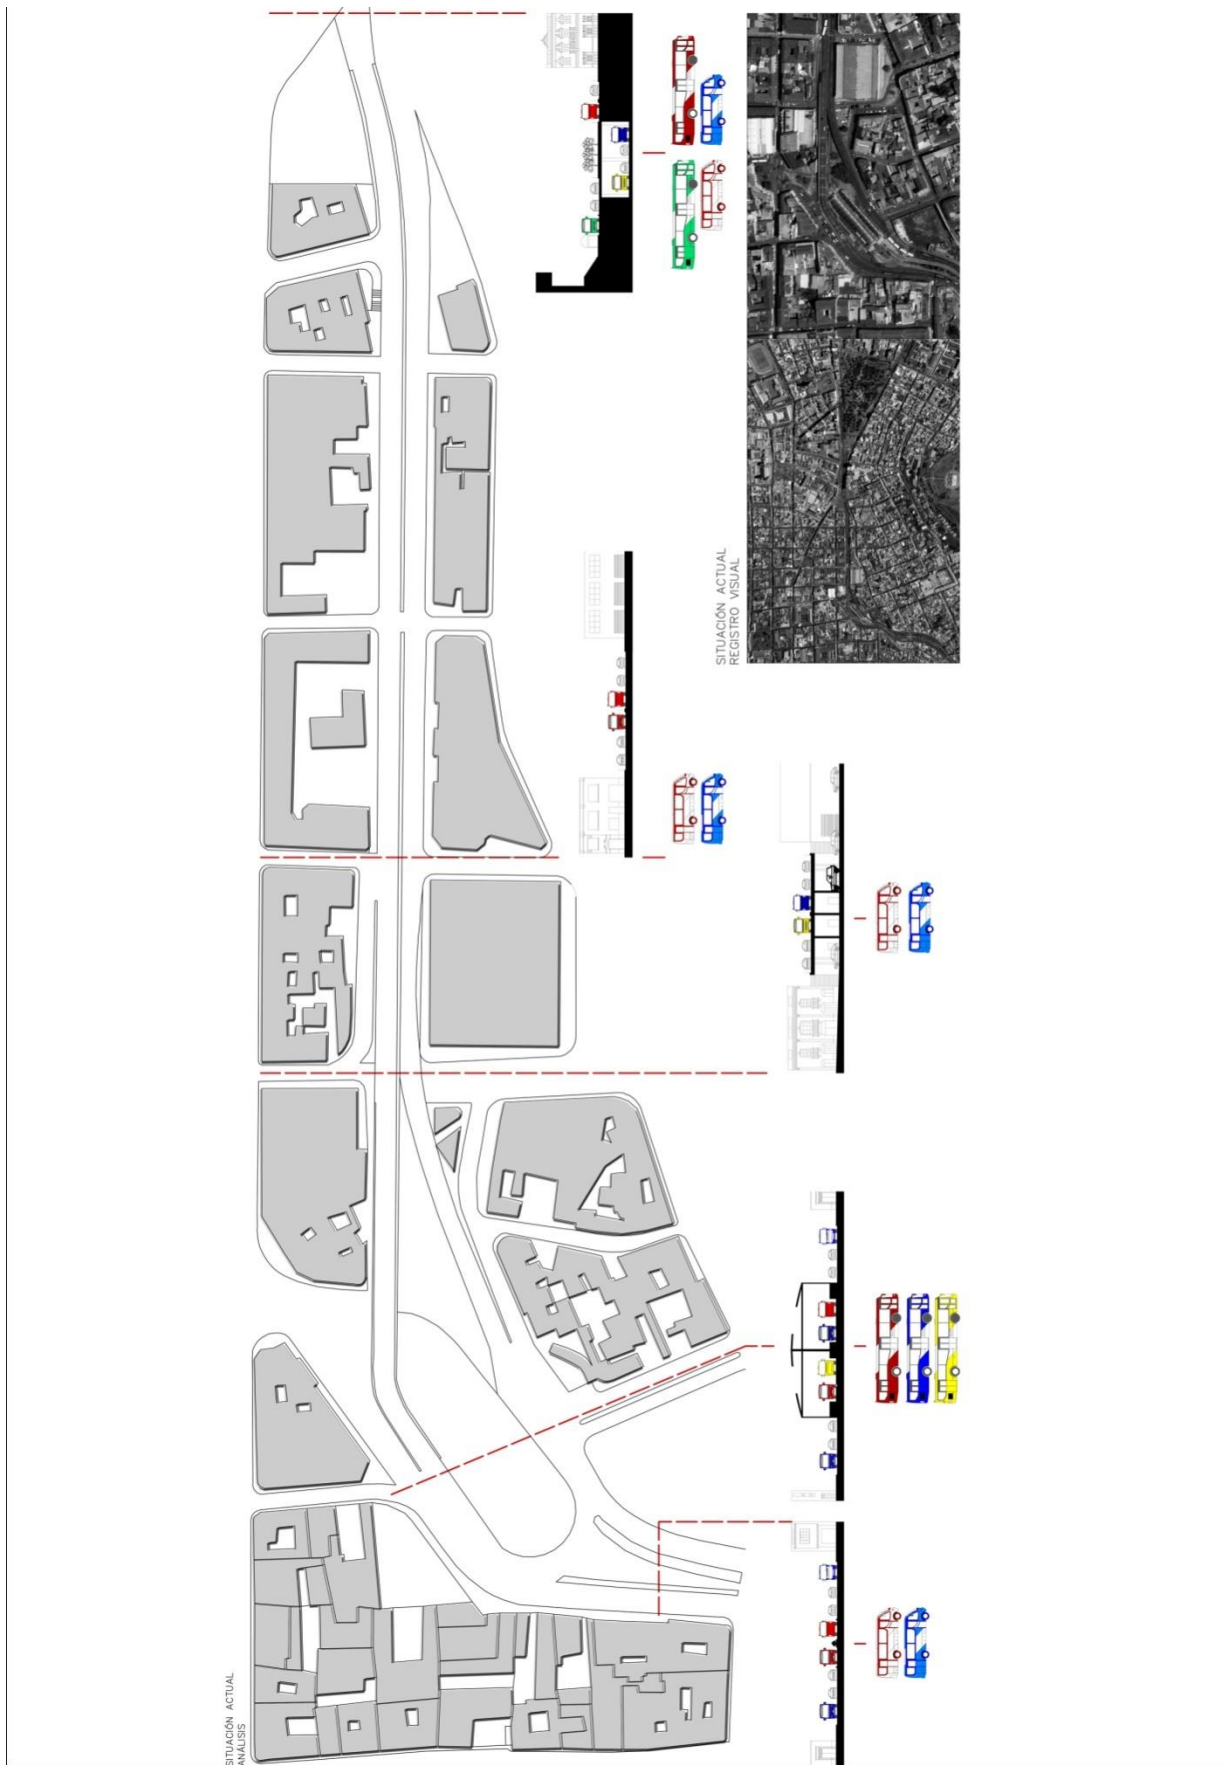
IMAGEN DE LA CIUDAD. FACHADAS PIEGAS Y CORTE DE LA RELACION DEL EDIFICIO CON LA CALLE.
